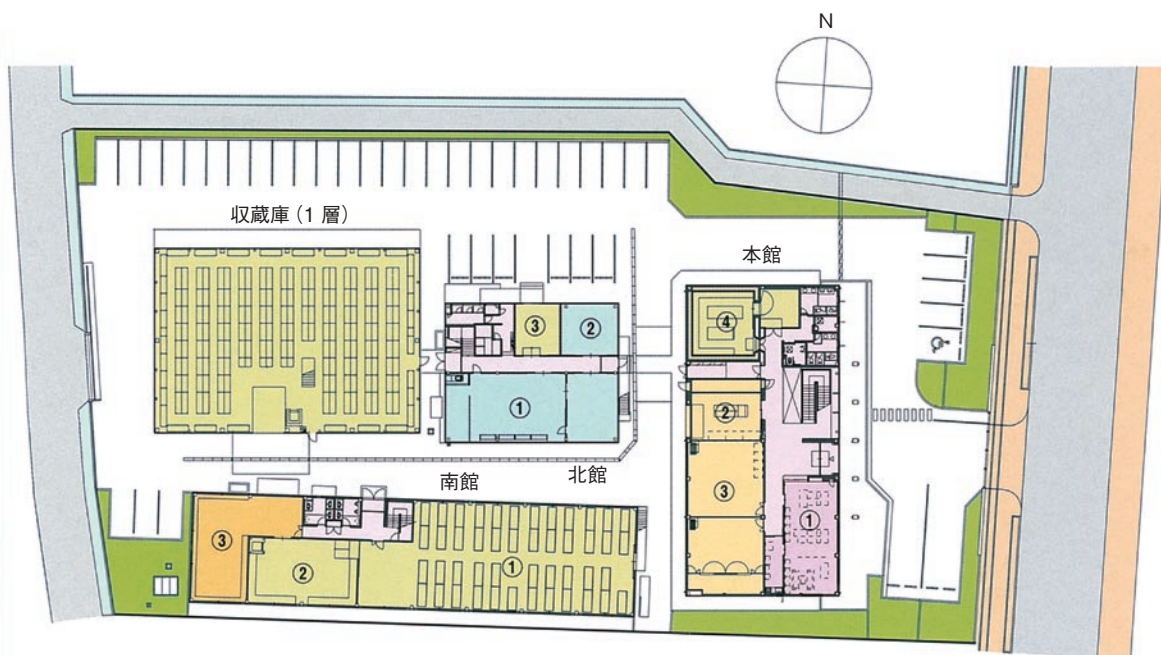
高知県立埋蔵文化財センター敷地と1F平面図(S=1/800)
